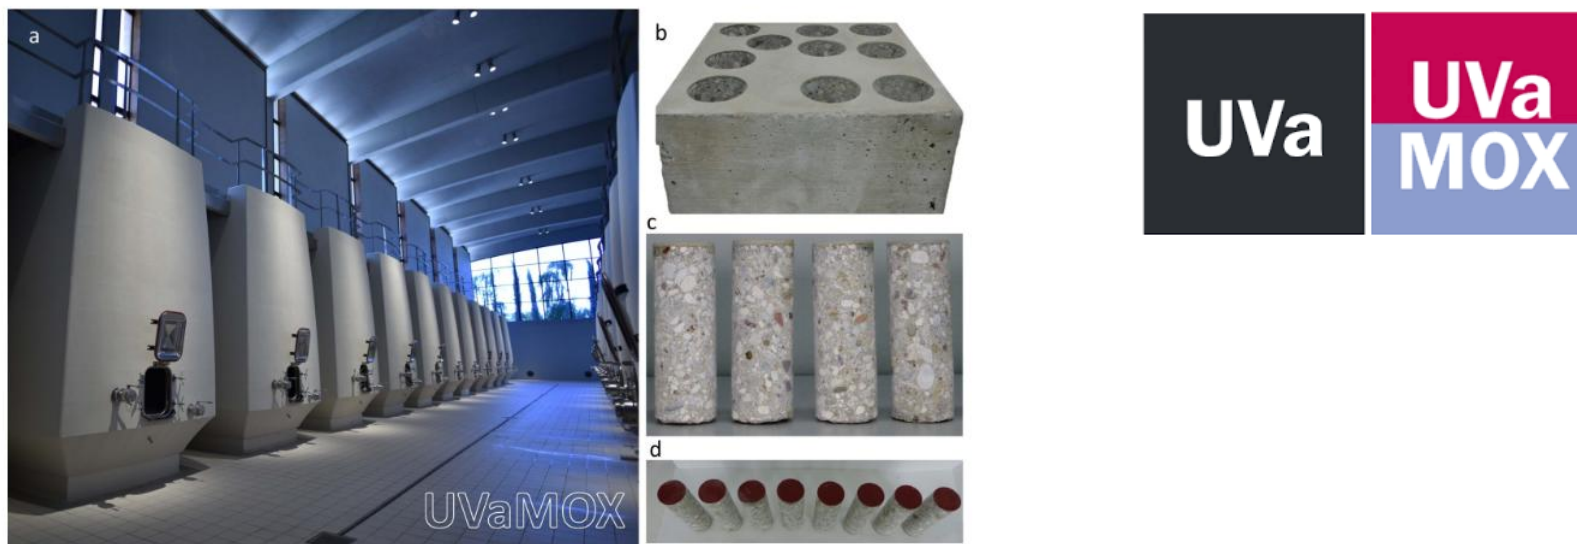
Vista de a) bloques de hormigón fabricados con el hormigón analizado (Bodegas Ramón Bilbao, España), b) vista de un bloque de hormigón, y c) muestras seleccionadas para el análisis y d) otras piezas similares pero tratadas con epoxi en su interior
